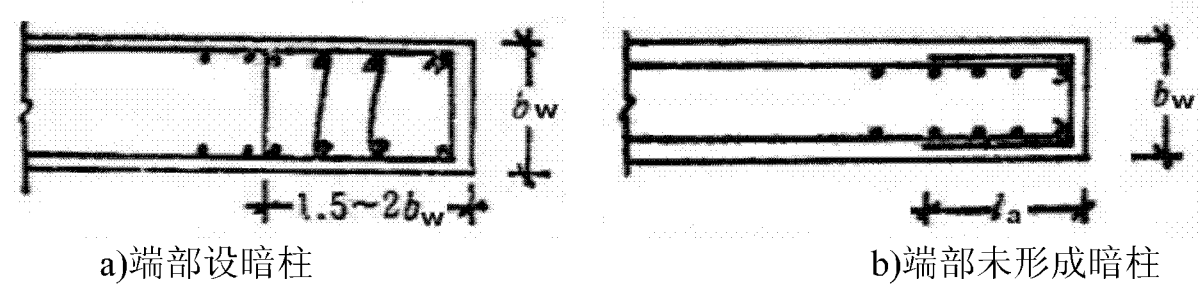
剪力墙水平分布钢筋在段部的锚固
